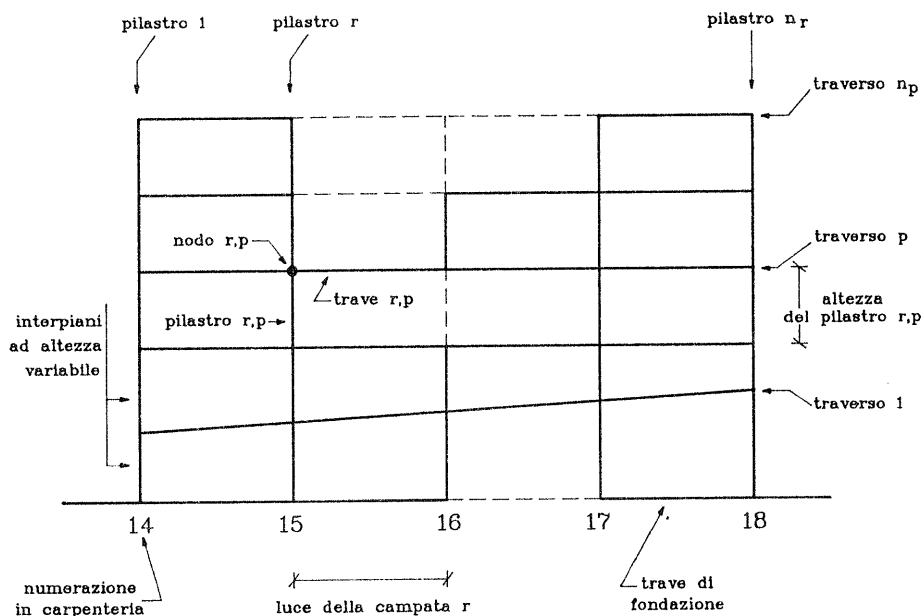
Telaio a maglie trapezie con trave di fondazione ed aste mancanti
